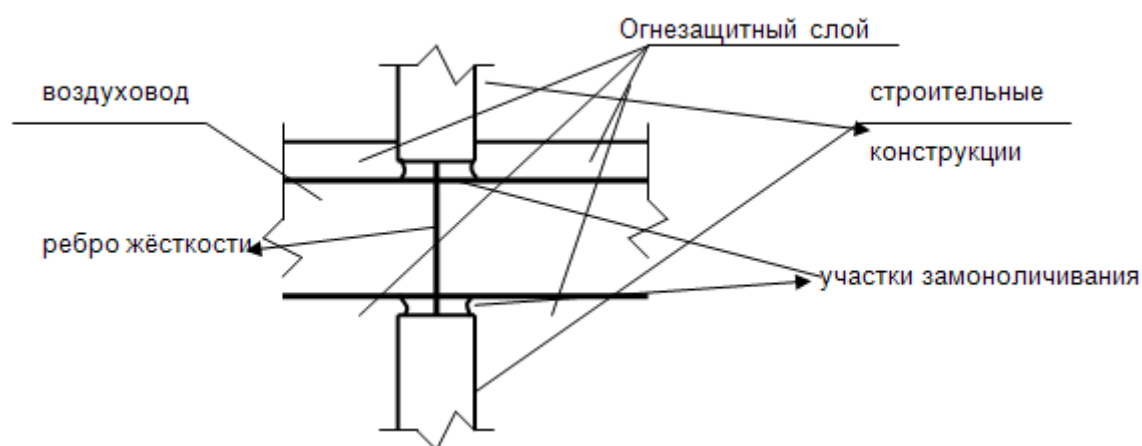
Принципиальная схема пересечения воздуховодом строительной конструкции.
